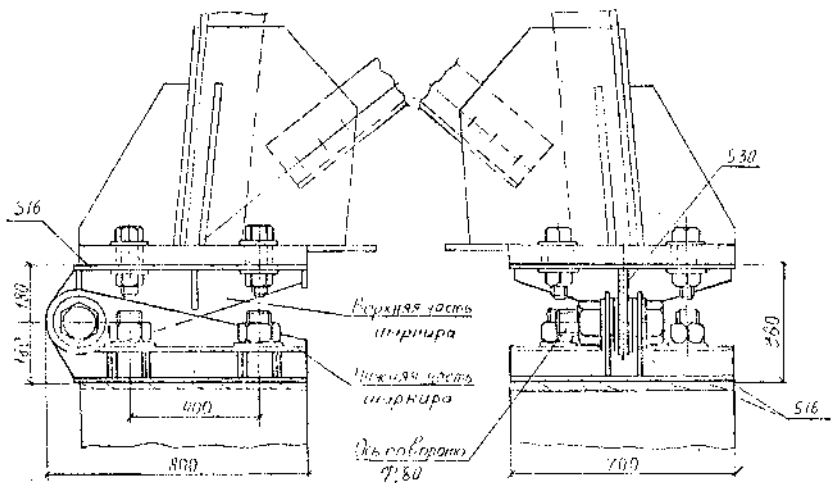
Вариант закрепления опоры на фундаменте с анкерными шляпками
